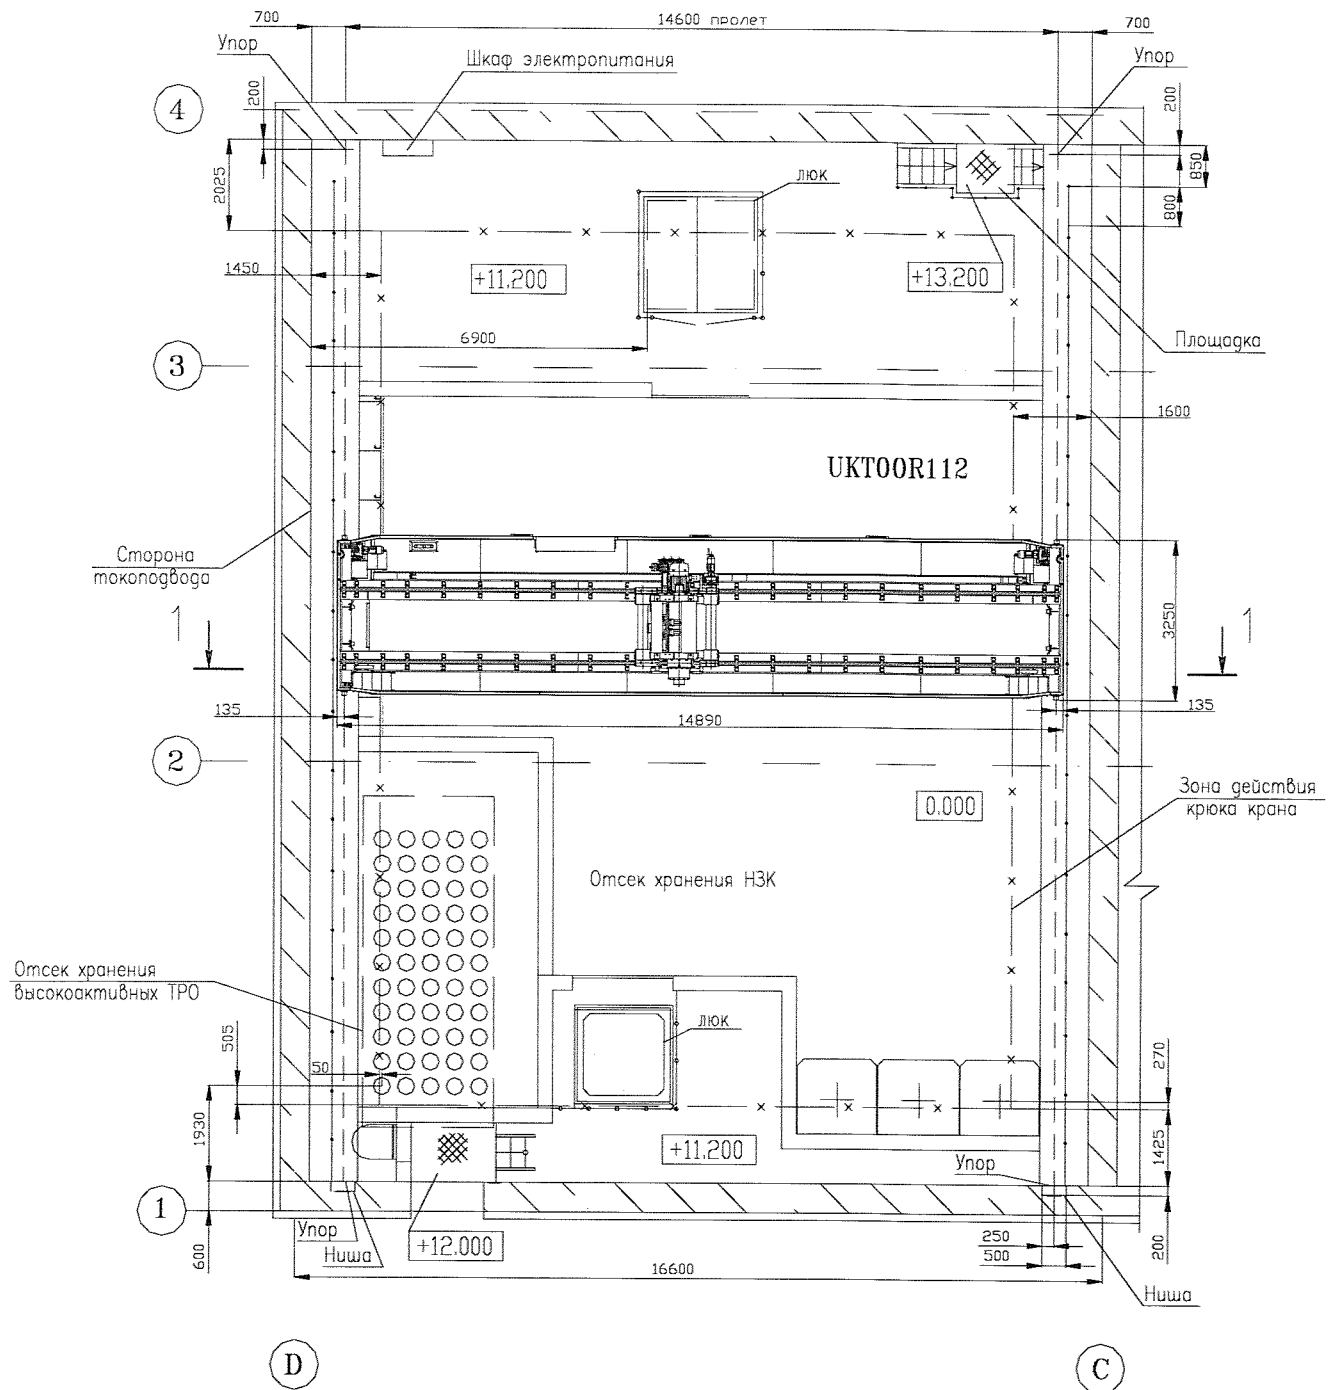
Кран мостовой электрический г/п 16т. План над отм.+15.000.
